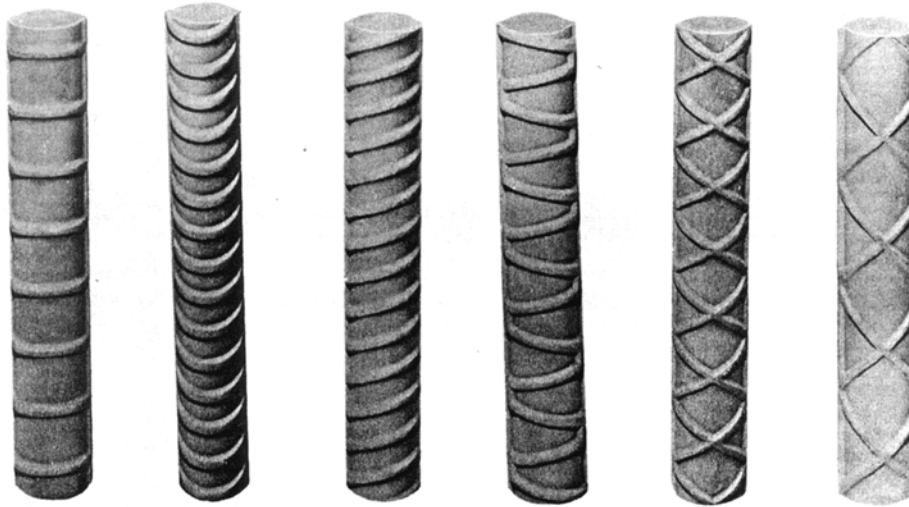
Tipos de corrugaciones en las barras de refuerzo.
